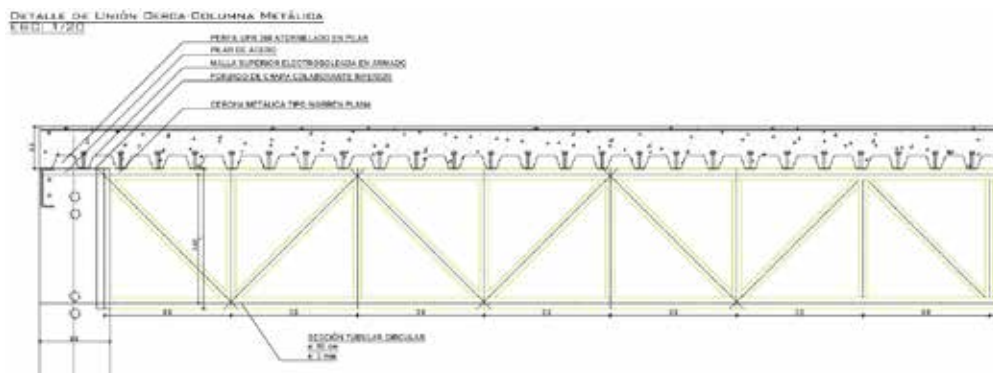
Detalle de Unión Cercha-Columna Metálica. Fuente: Adrian Colombet. (2020)
